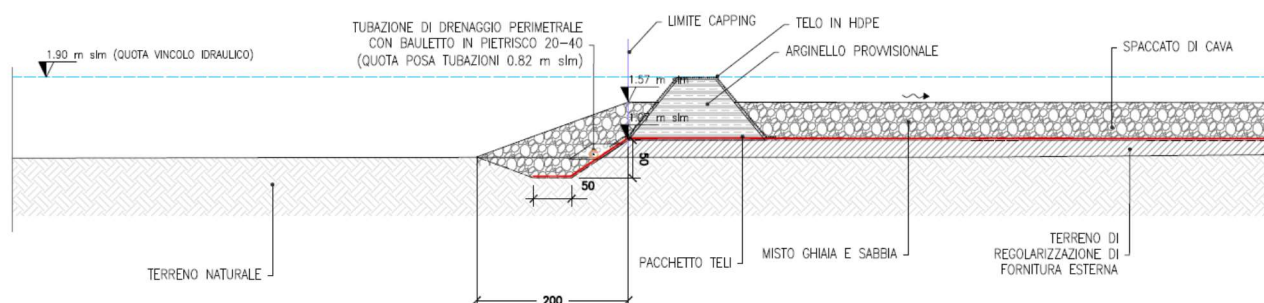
Sezione stato atteso ad inizio cantiere (stralcio elaborato 090026-ENG-D-DA-3068)
